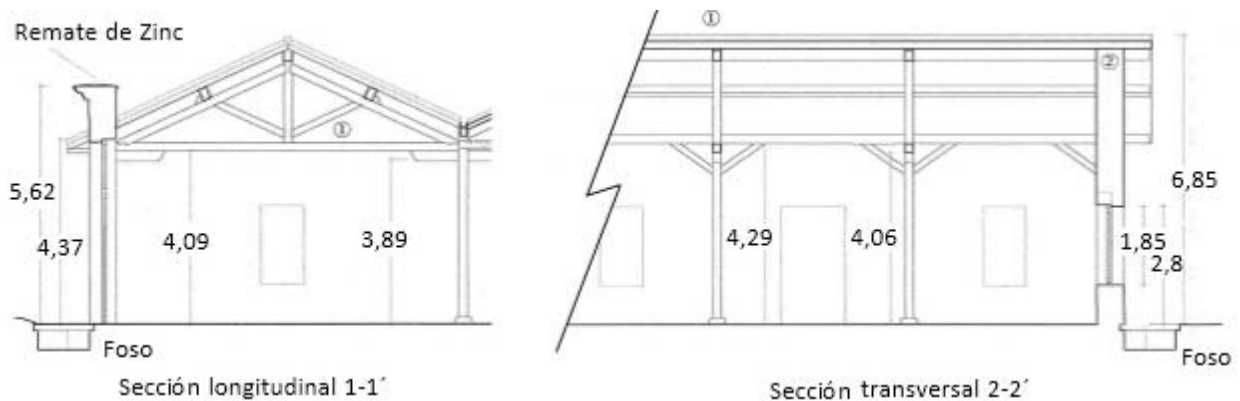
Dársenas de picos de Alar del Rey. Secciones de planos de alzados (Sanz, 2008).
